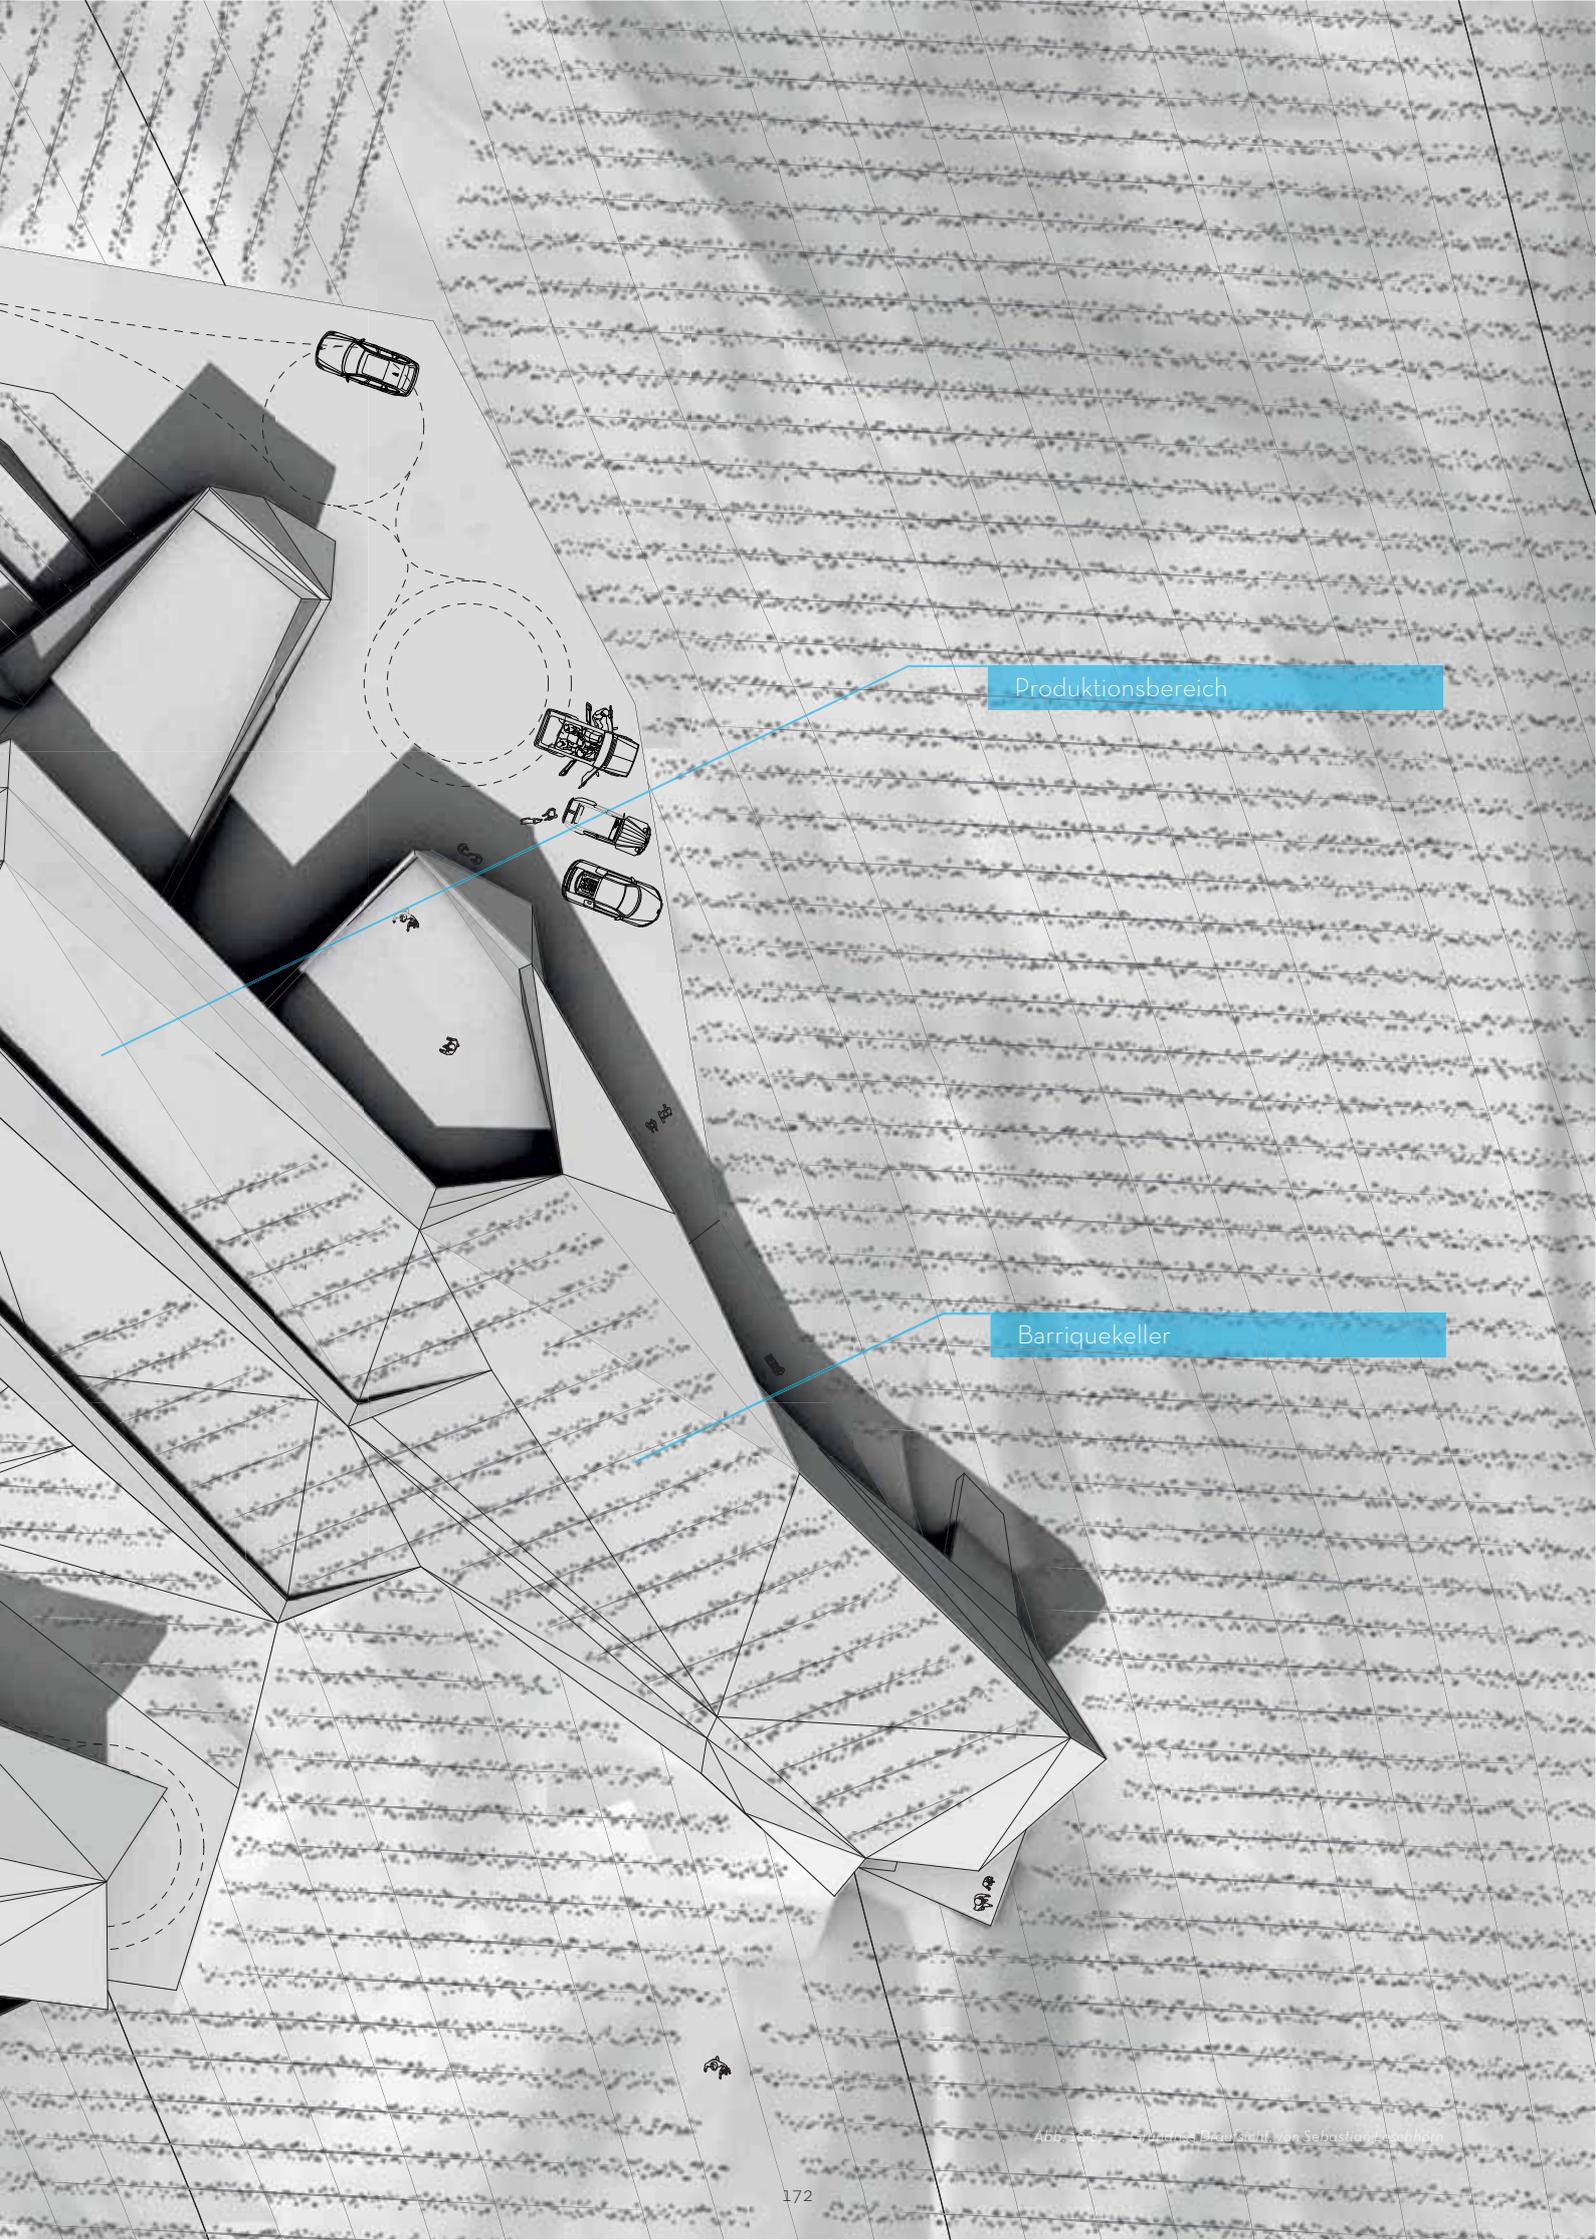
Grundriss Ebene 01 von Sebastian Eschhorn
